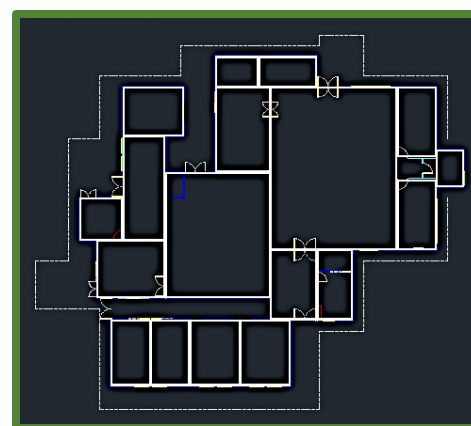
Análisis de Planta Arquitectónica Servicios Generales
